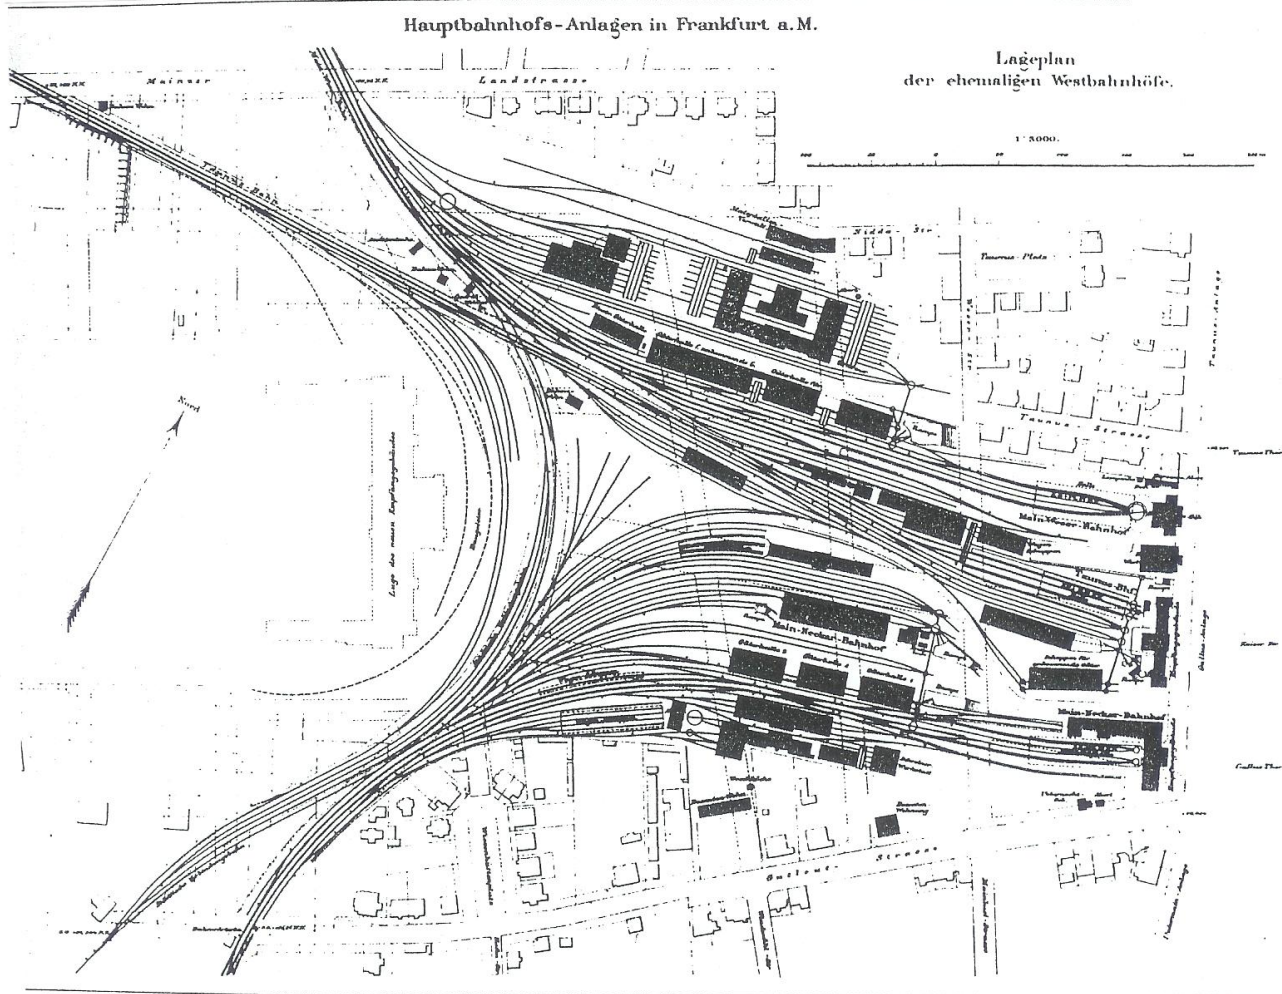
Frankfurt/Main: Lageplan der ehemaligen Westbahnhöfe mit projektiertem Hauptbahnhof, 1880.
